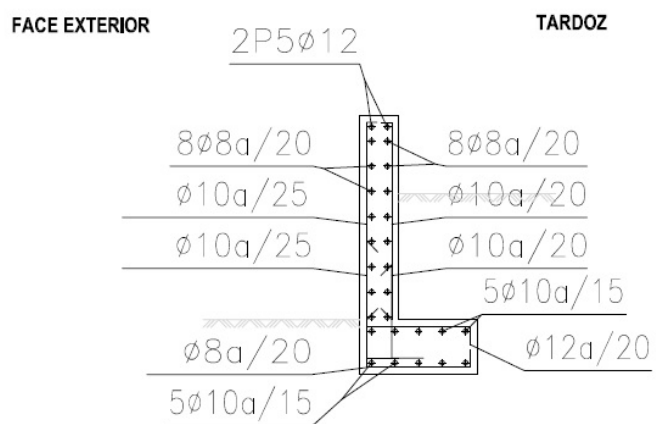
Pormenor da armadura do muro de suporte de terras confinante com a via pública.
